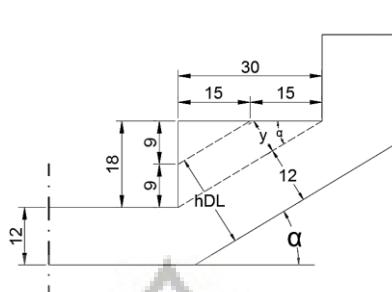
Denah Tangga Lantai Dasar-2 (Sumber: Data Pribadi, 2018)
